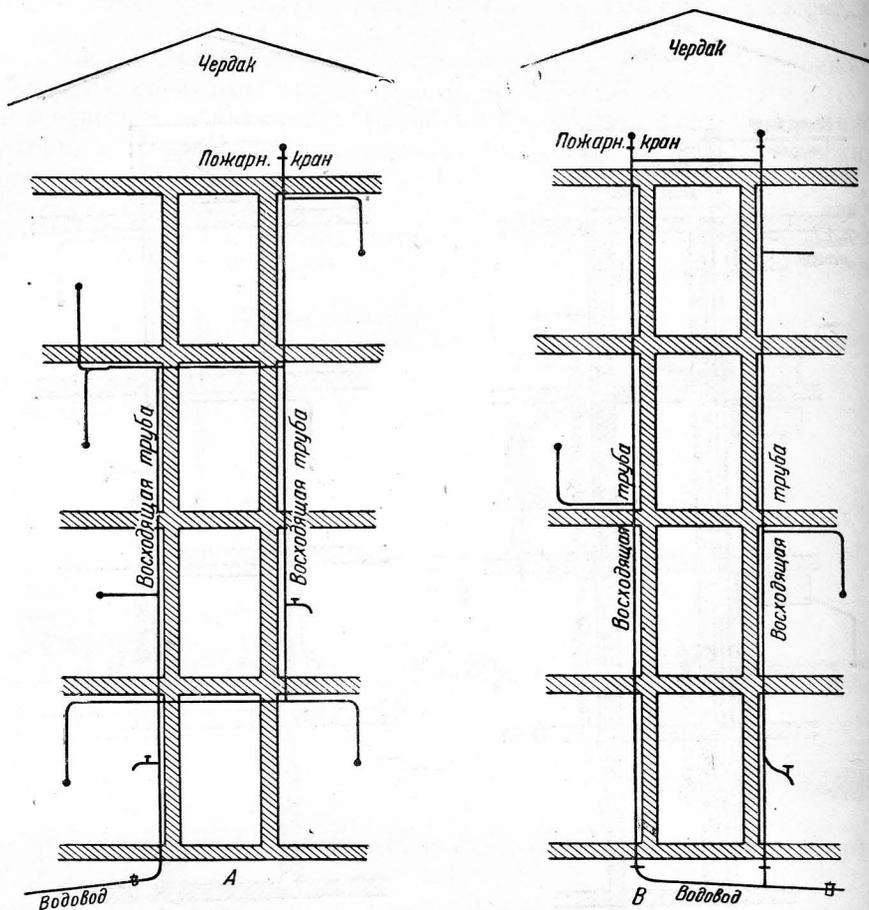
, б. Схемы домовых водопроводов (А. Штукенберг, 1878 г.).
